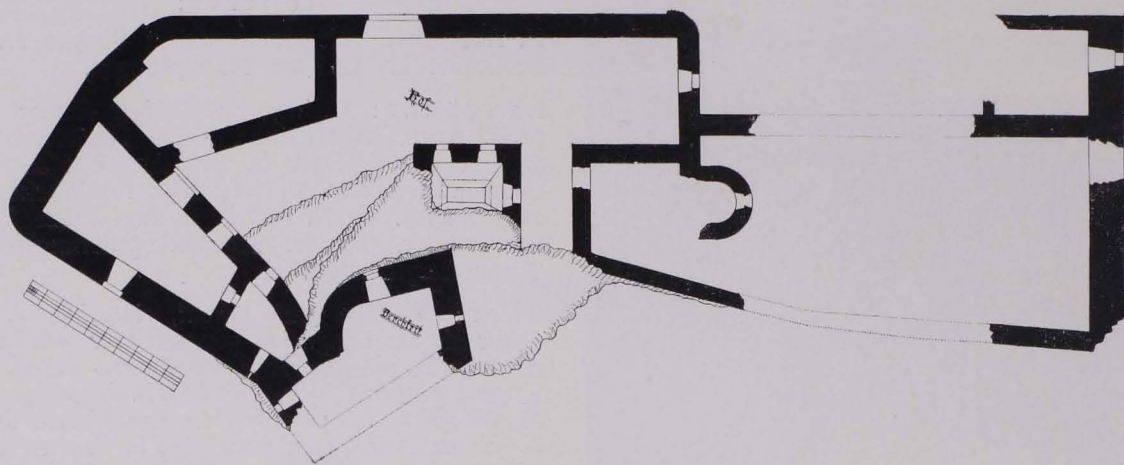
Eibenstein, Ruine, Grundriß, 1 : 400 (S. 60)
